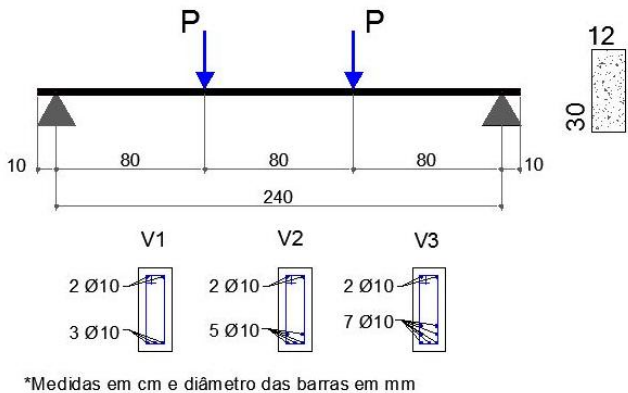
Geometria e armação das vigas ensaiadas por Fernandes (1996).
